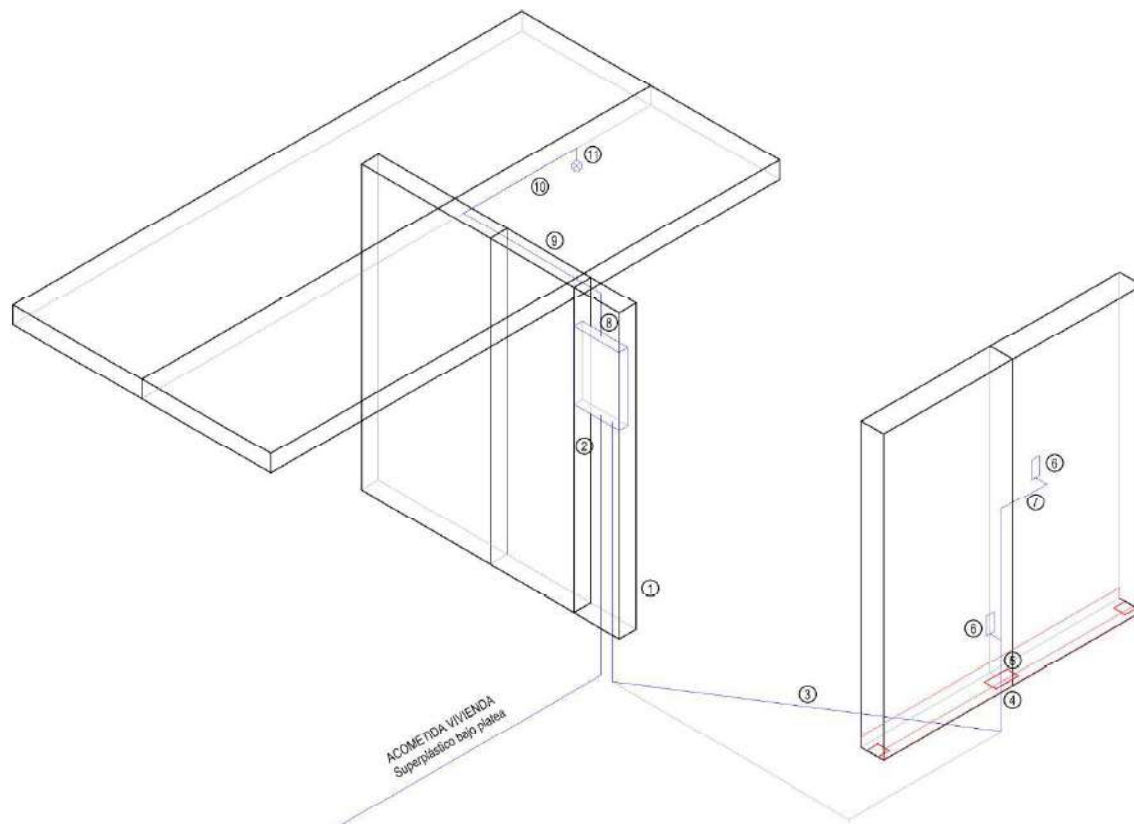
Detalle de la canalización de la instalación eléctrica entre las juntas de paneles SPM CIR
